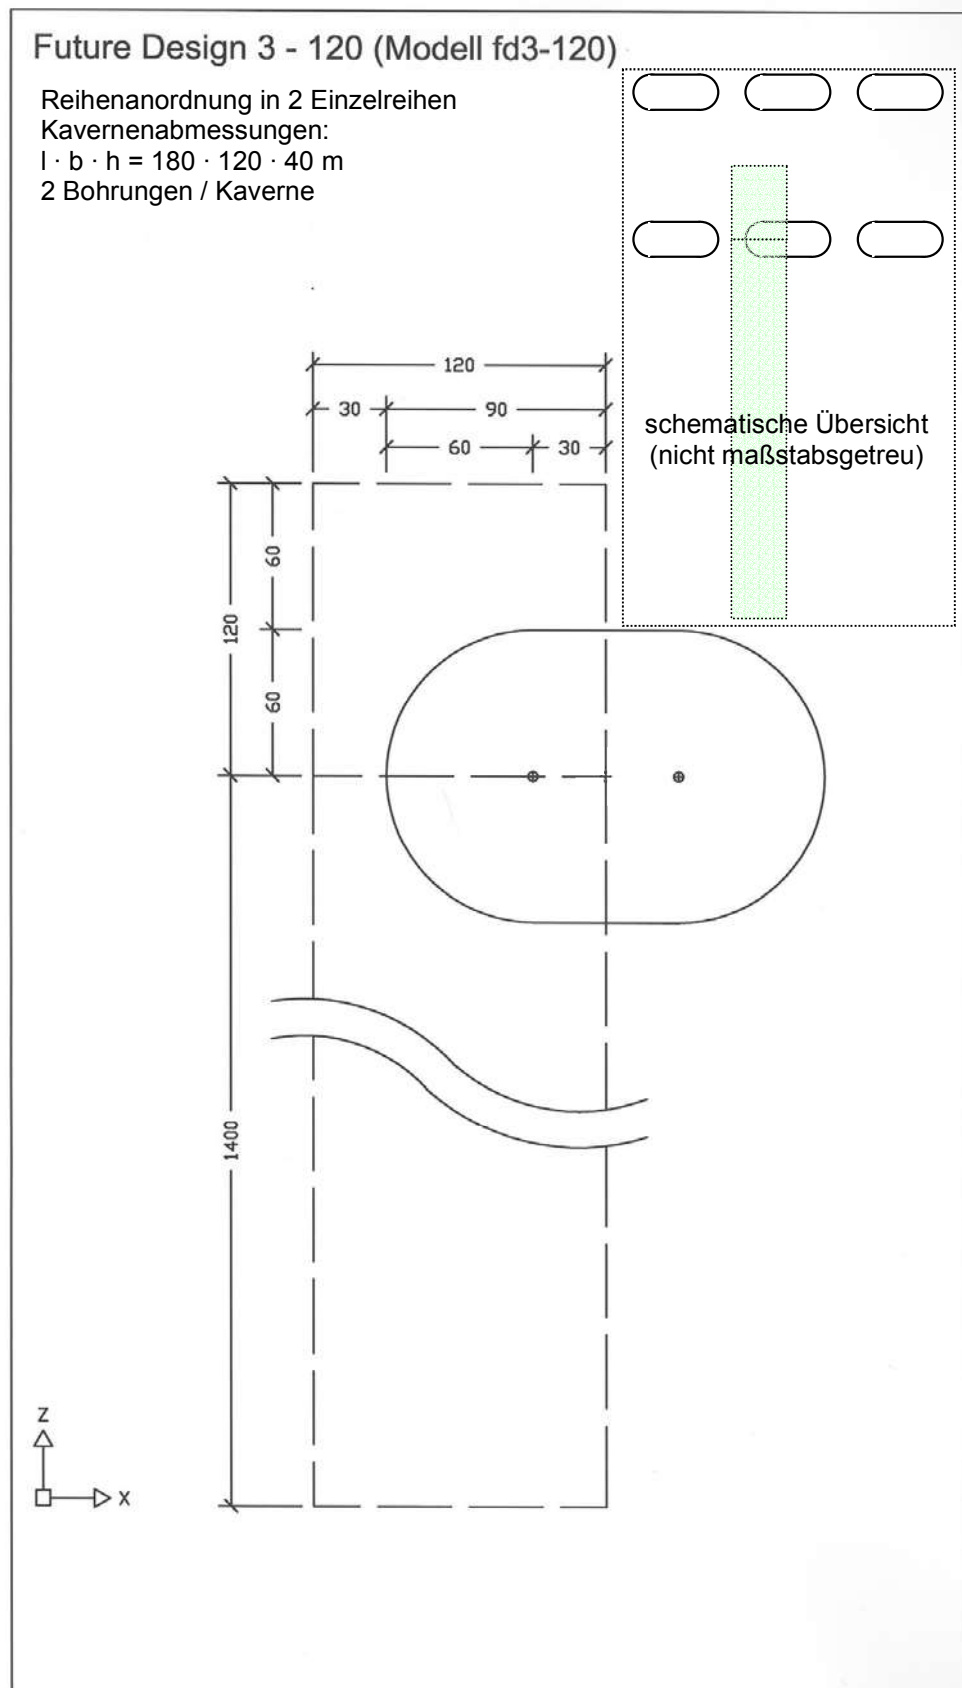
Future Design 3-120 – Grundriss
